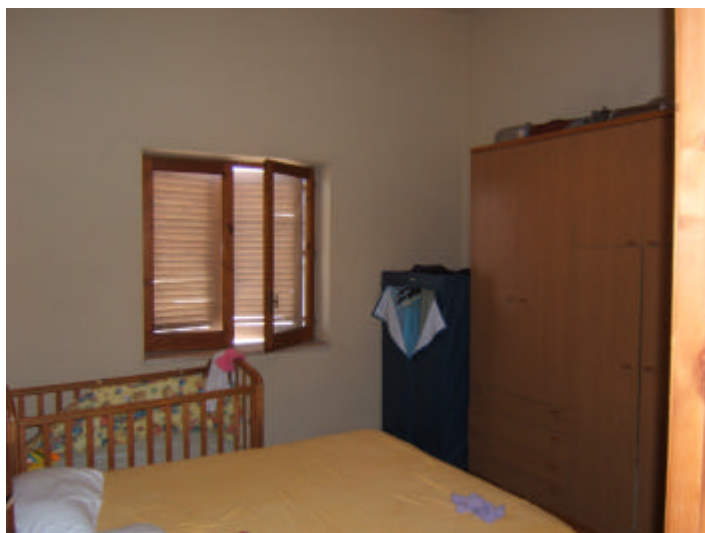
Lotto 2 – Camera con affaccio su via Napoli
